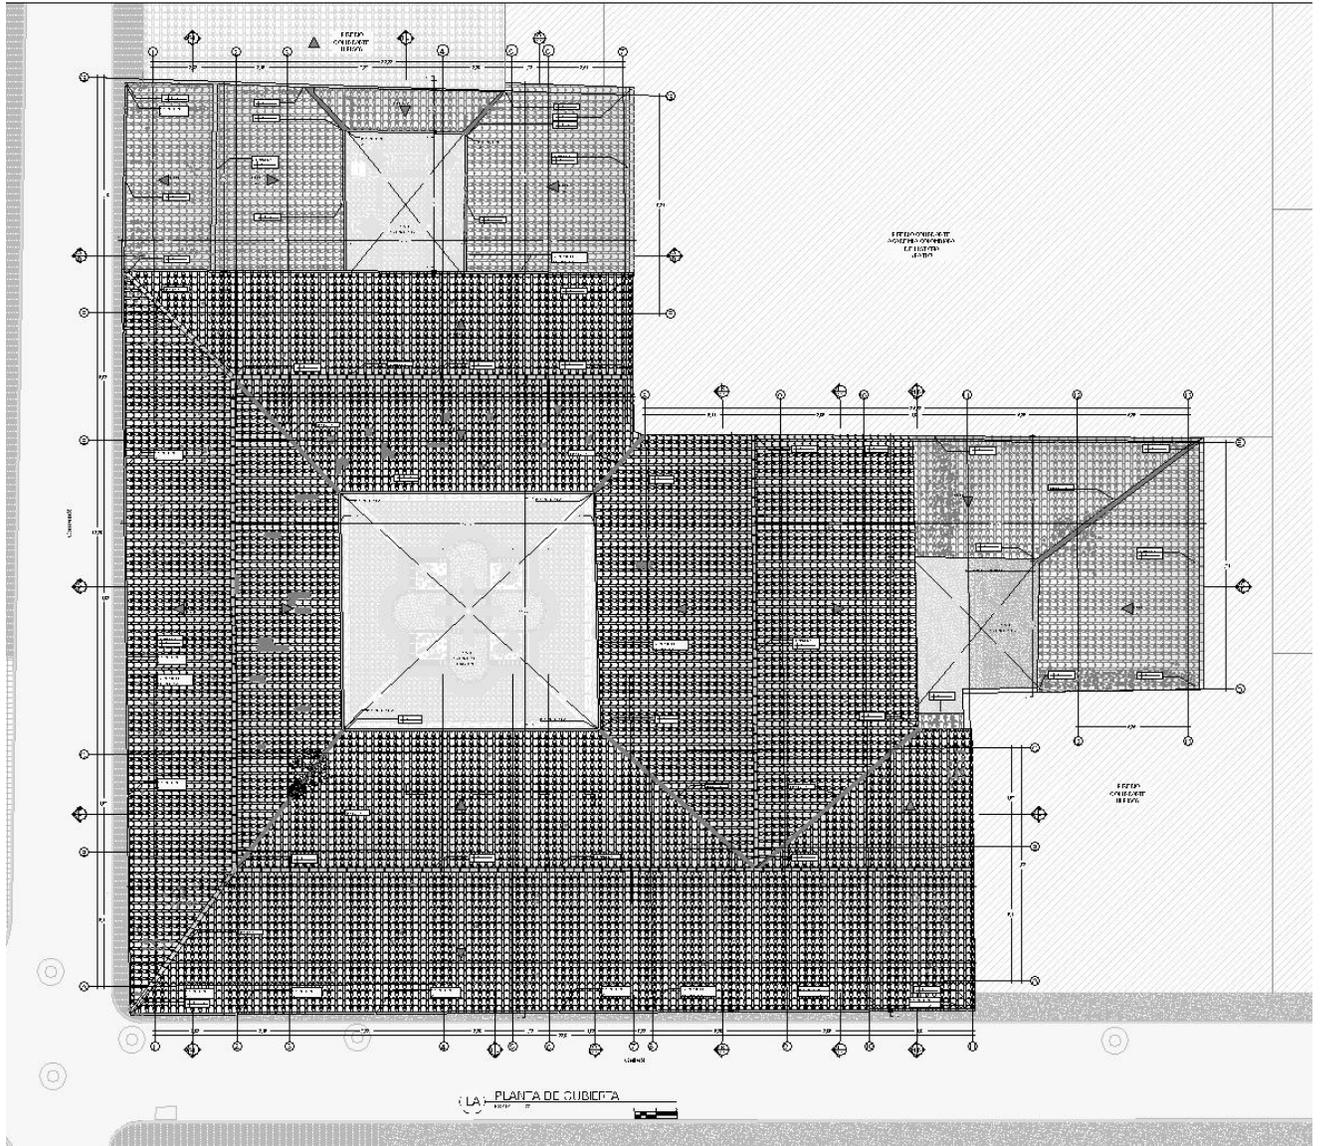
Levantamiento Planta de Cubierta. CRC coordinado MGC. Dic. 2013
